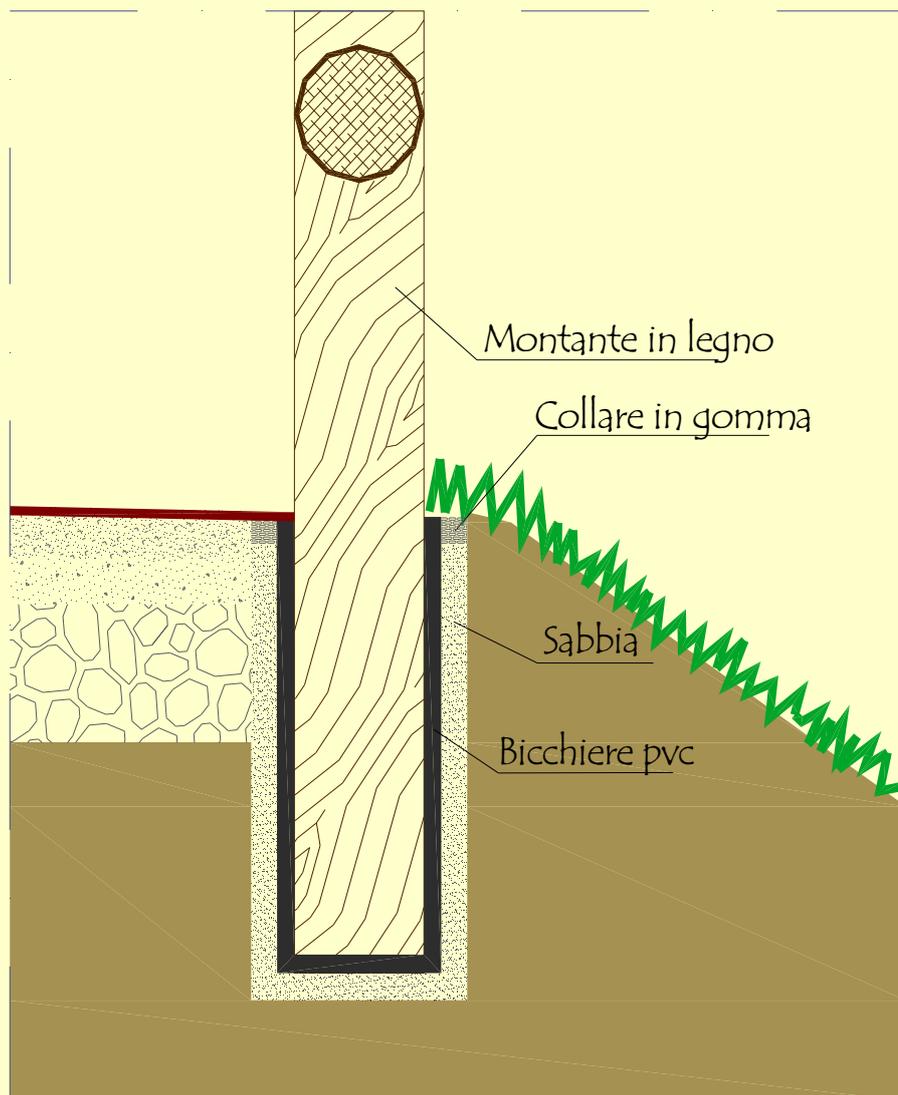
L'infissione del montante nel terreno può essere eseguita con bicchiere in PVC che ne permette un facile smontaggio
